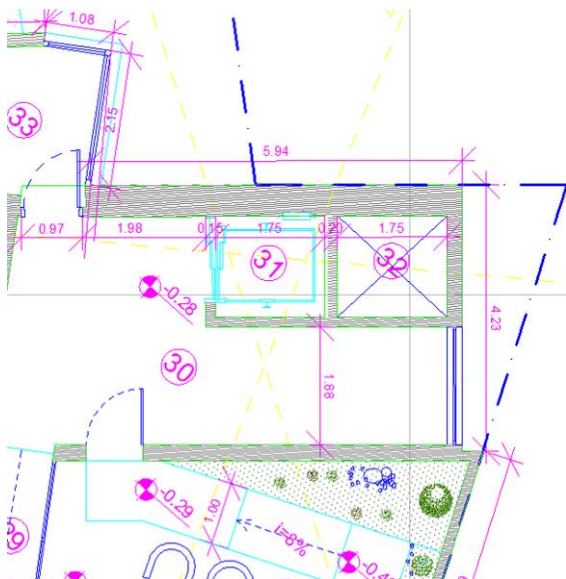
Planta piso -1 na zona da torre do elevador [AtelierB2, 2016]
